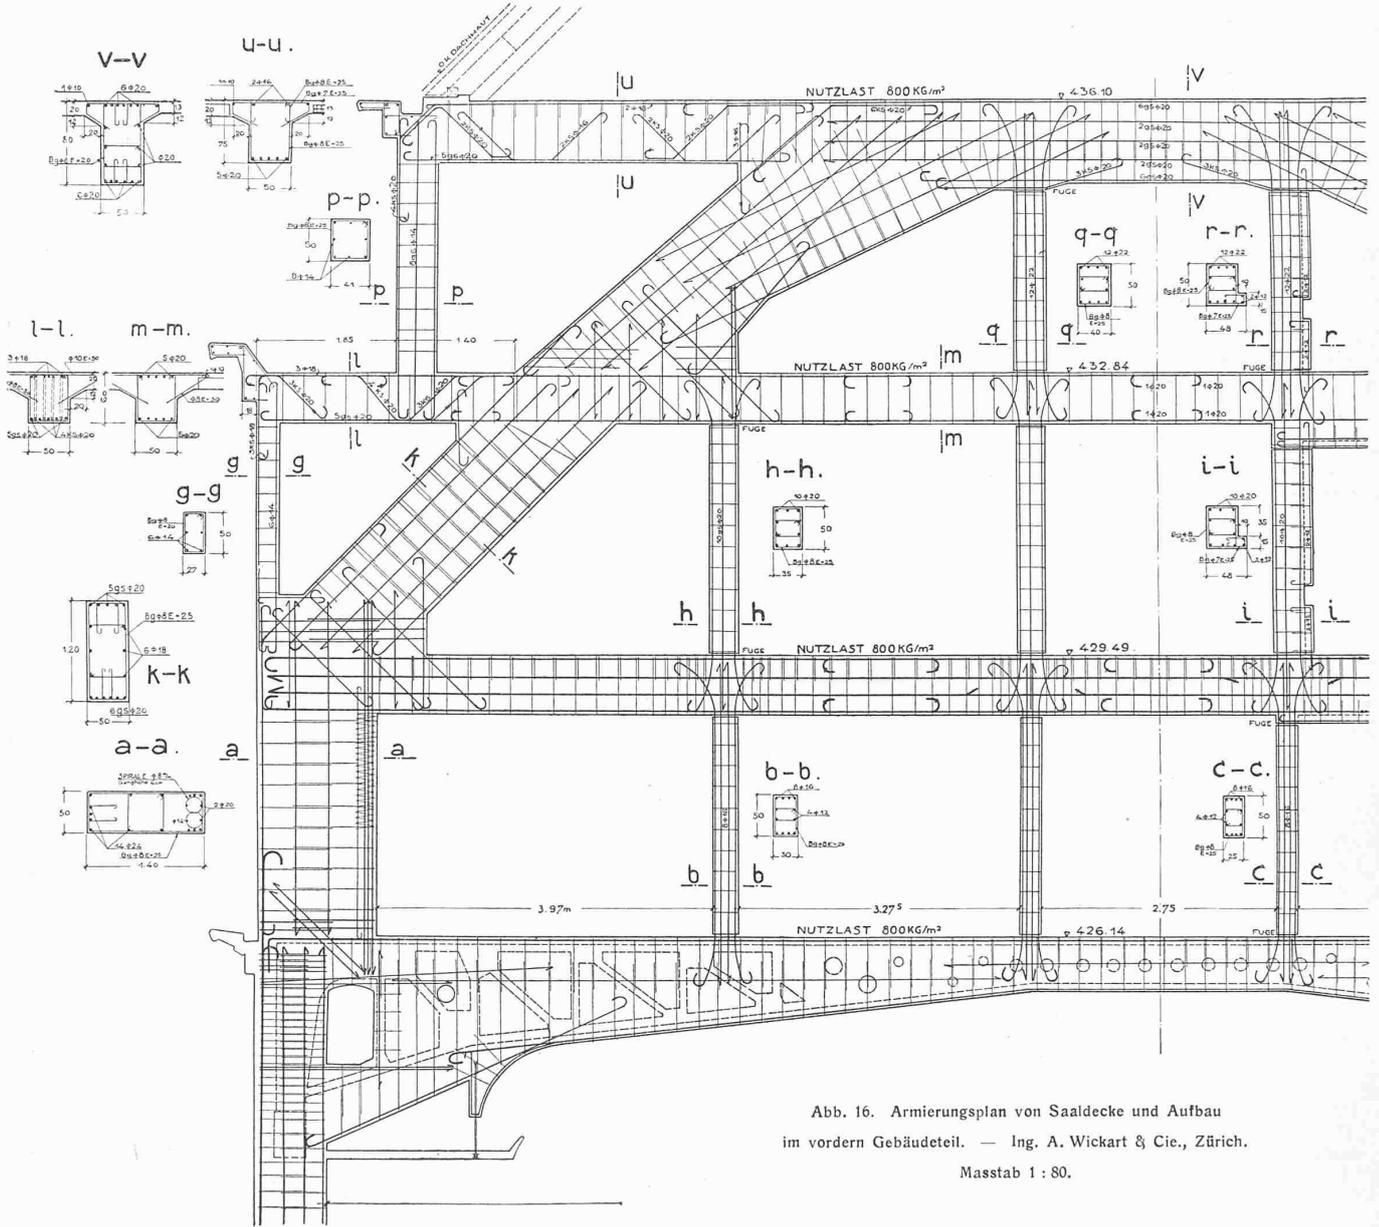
Armierungsplan von Saaldecke und Aufbau
